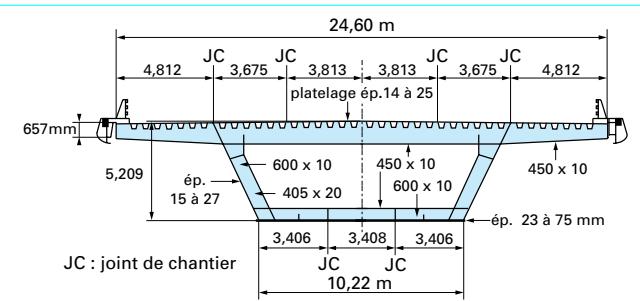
Tablier en caisson orthotrope de la travée centrale (162 m) du pont de Cheviré
